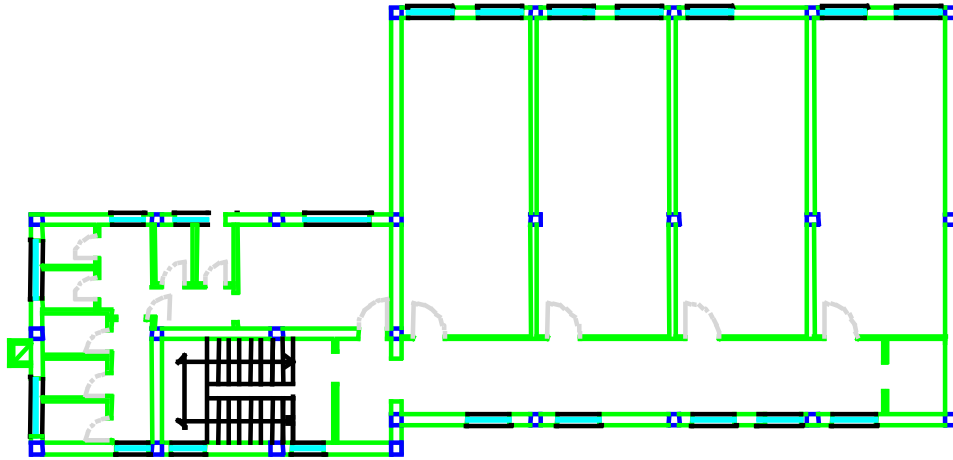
Pianta 1°e 2° Piano, configurazione attuale
